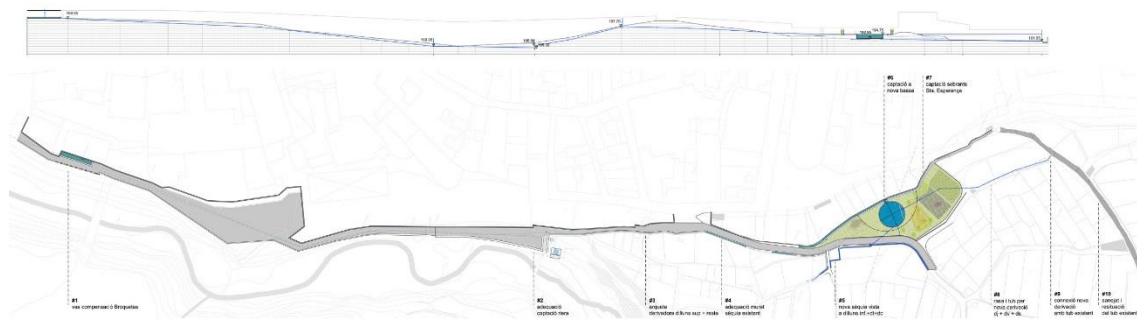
Planta y sección longitudinal del emplazamiento indicando zonas de intervención.
